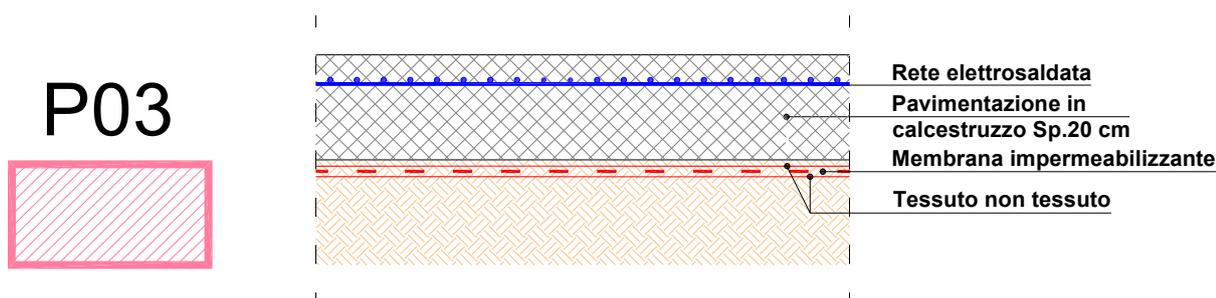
Interventi di pavimentazione tipo P03 – Nuove pavimentazioni impermeabili.
